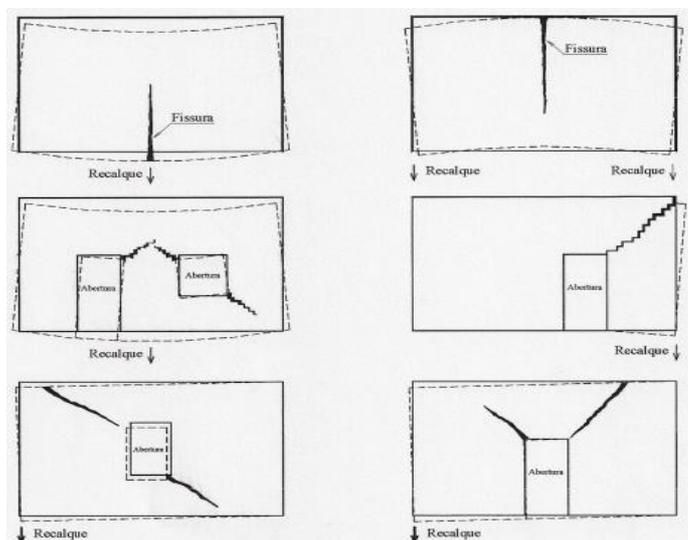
Fissuração extensa e assentamentos diferenciais das fundações
